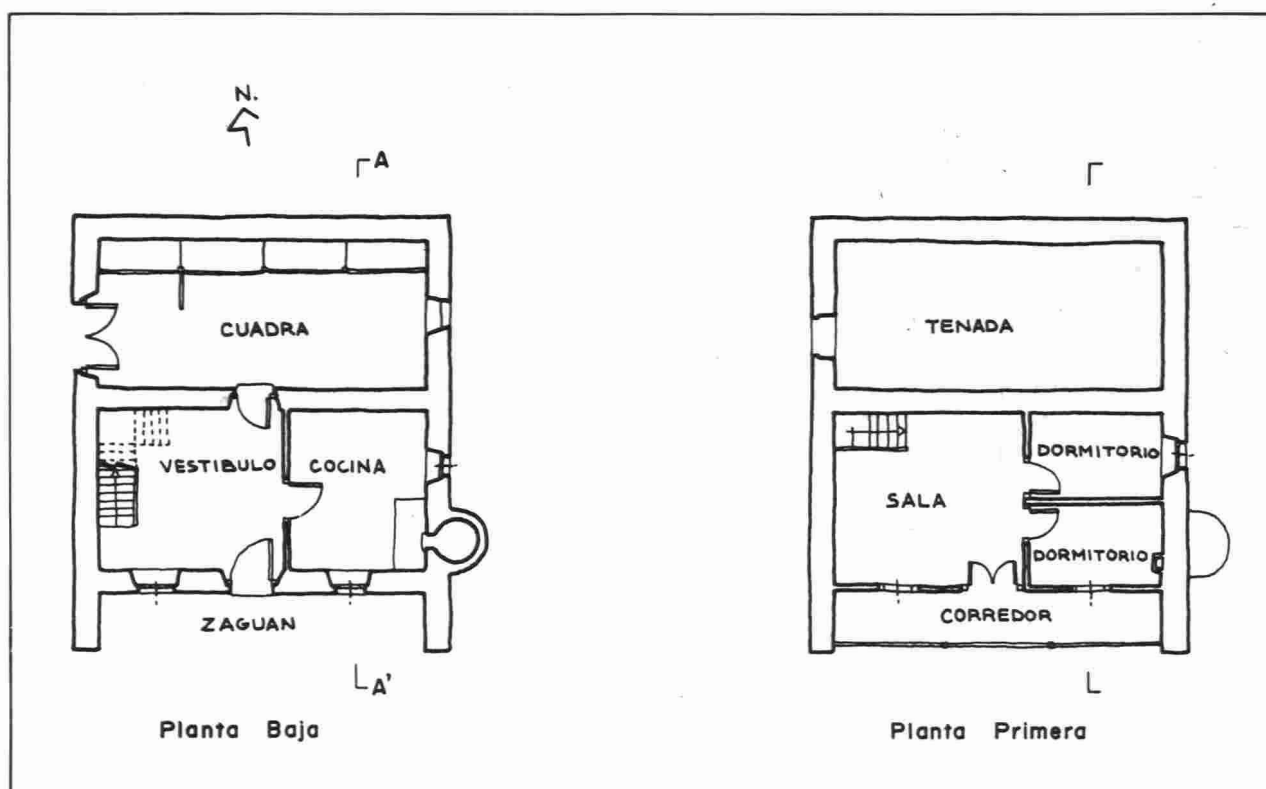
Planta tipo de casa con corredor entre muros cortafuegos.
